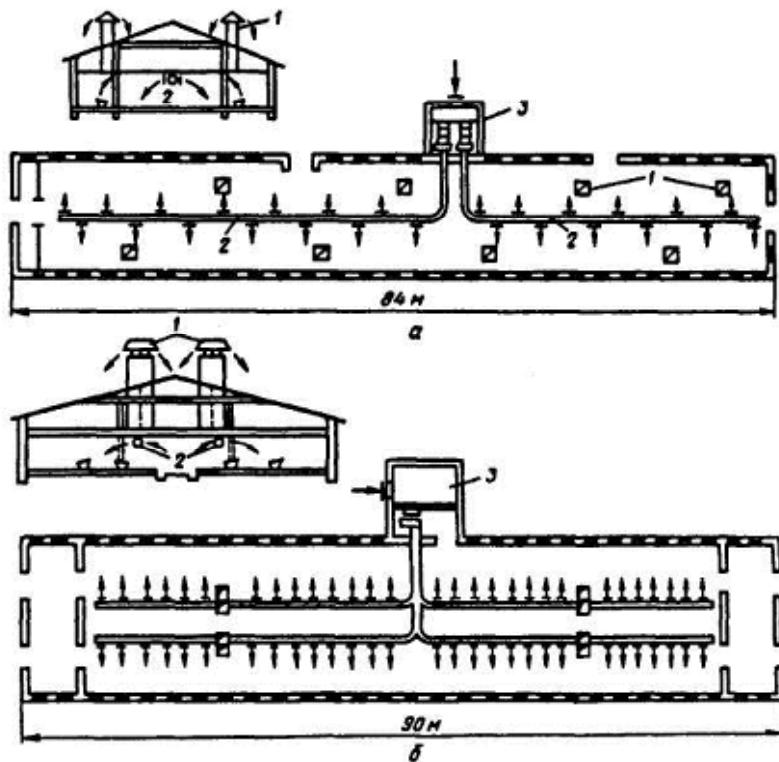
Схема вентиляции коровника при ширине помещения: а - 12 м; б - 18 м; 1 - вытяжные шахты; 2 - приточные воздуховоды; 3 - вентиляционная камера
